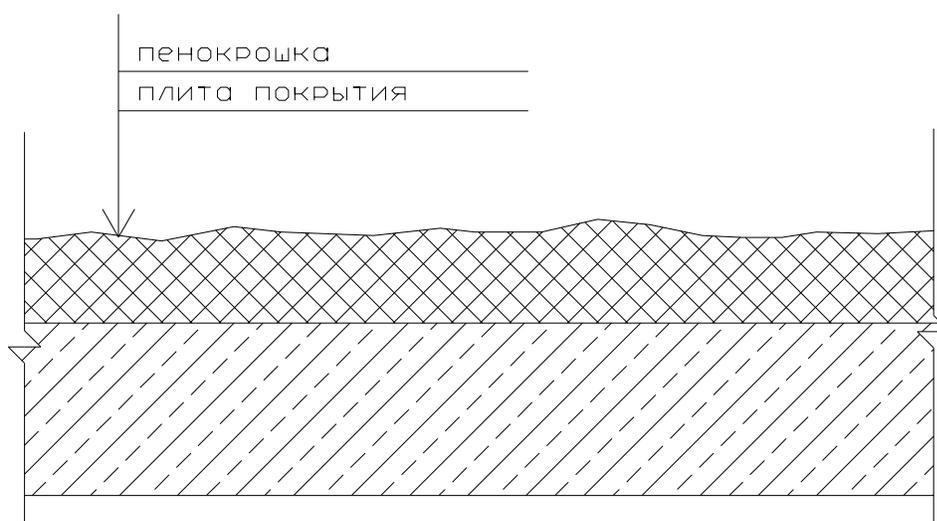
Тепловая изоляция не эксплуатируемого чердачного перекрытия
